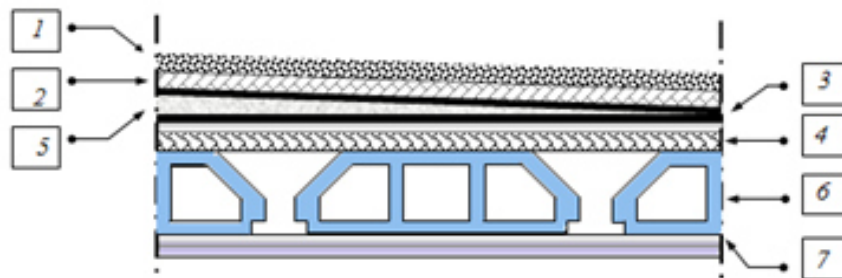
Constituants du plancher terrasse inaccessible corps creux
